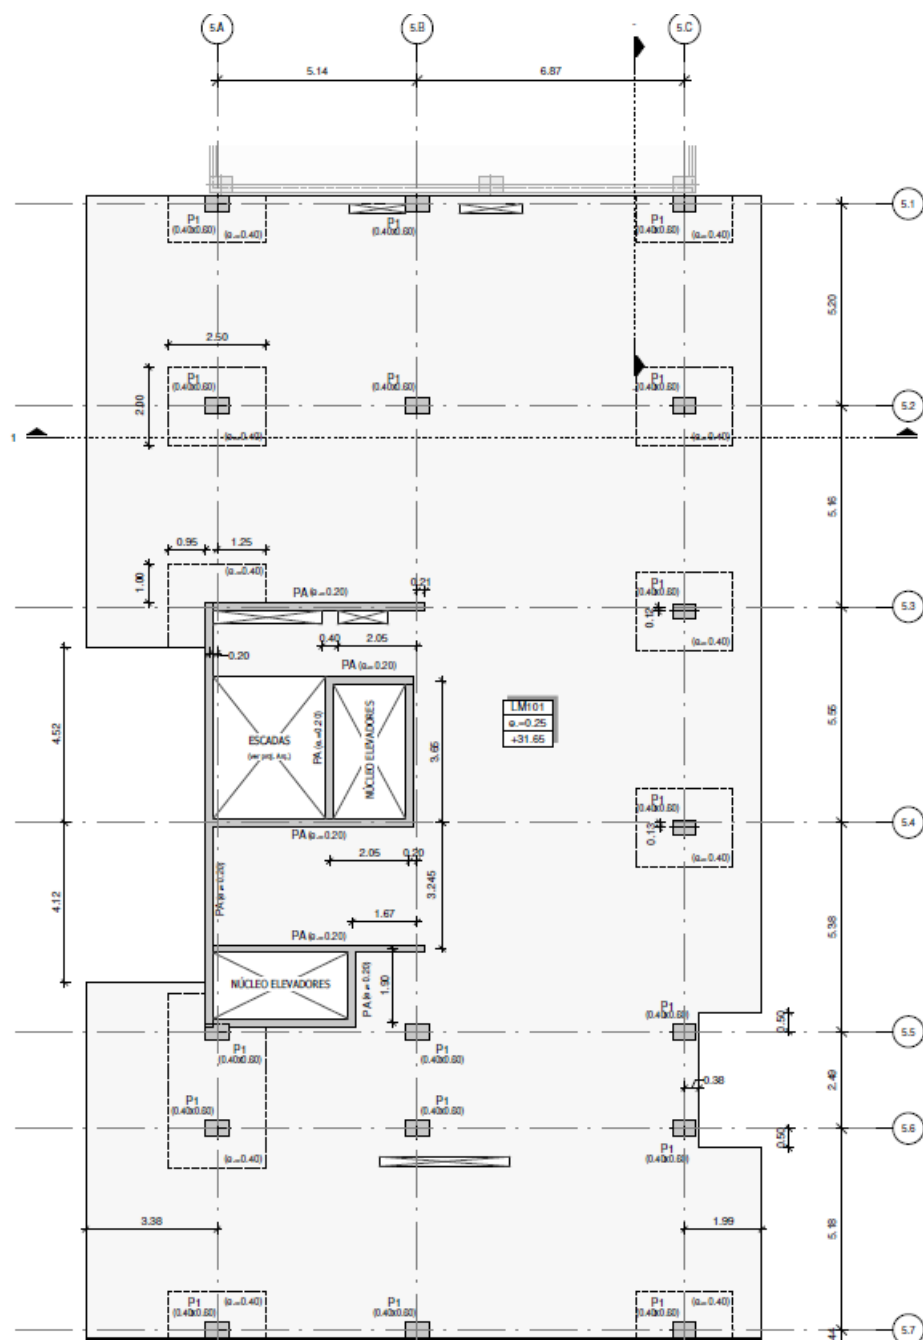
Planta estrutural Piso Tipo 1 (Revit)
